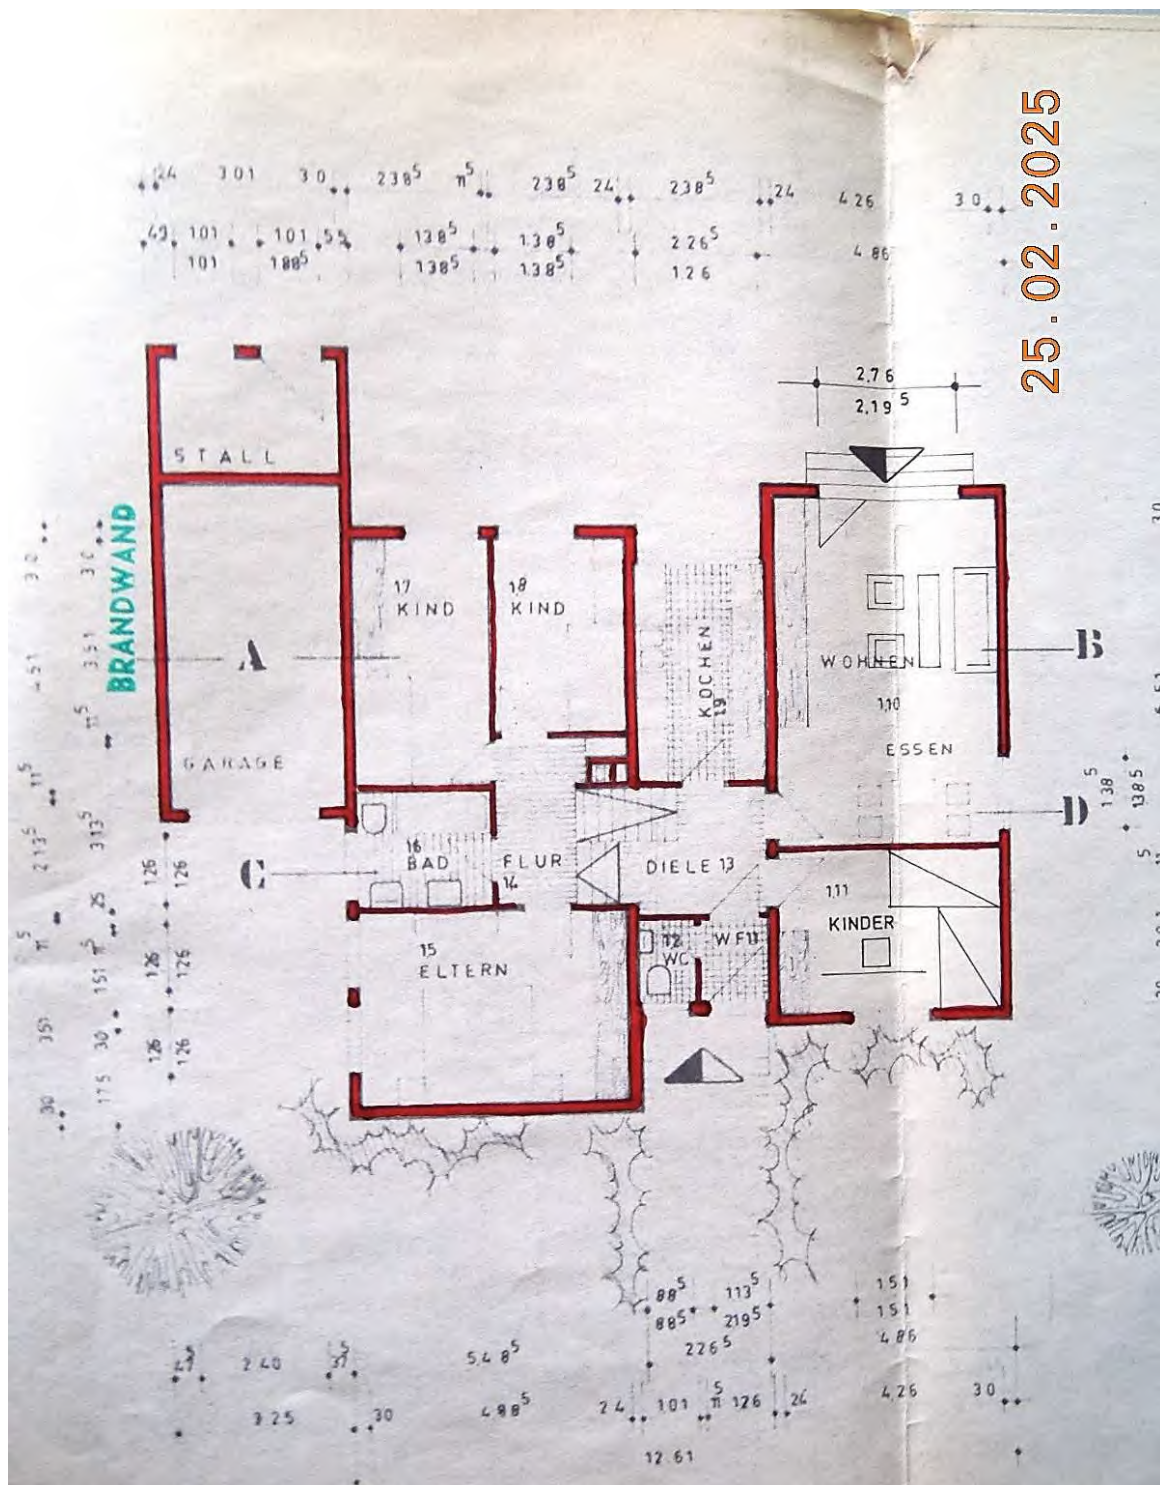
Grundrissplan Erdgeschoss (aus Bauakte 1972)
